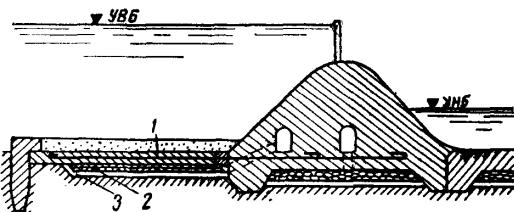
Горизонтальный дренаж под фундаментной плитой и анкерным понуром
